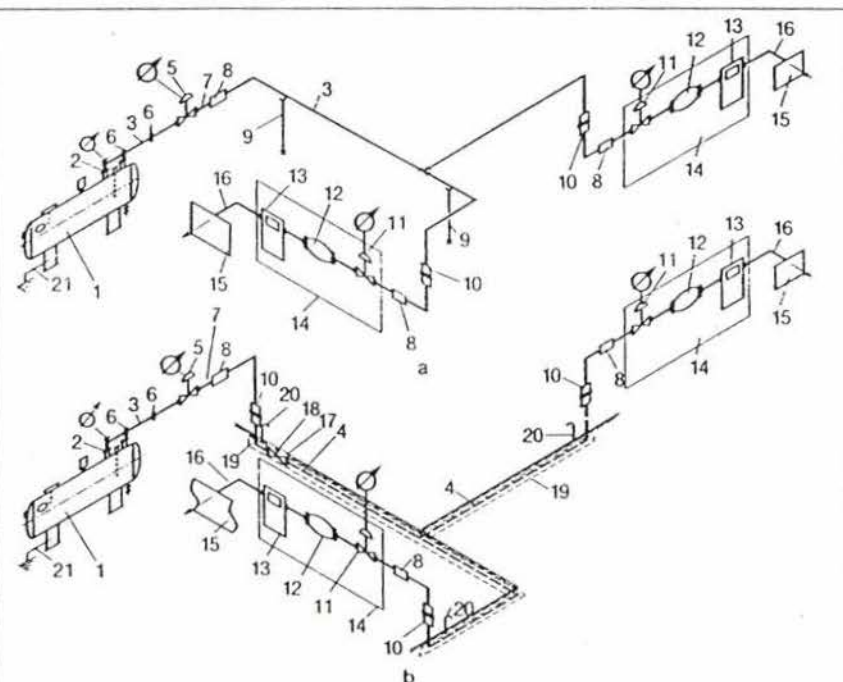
Schemele instalațiilor de depozitare a gazelor petroliere lichefiate, în recipiente stabile:
